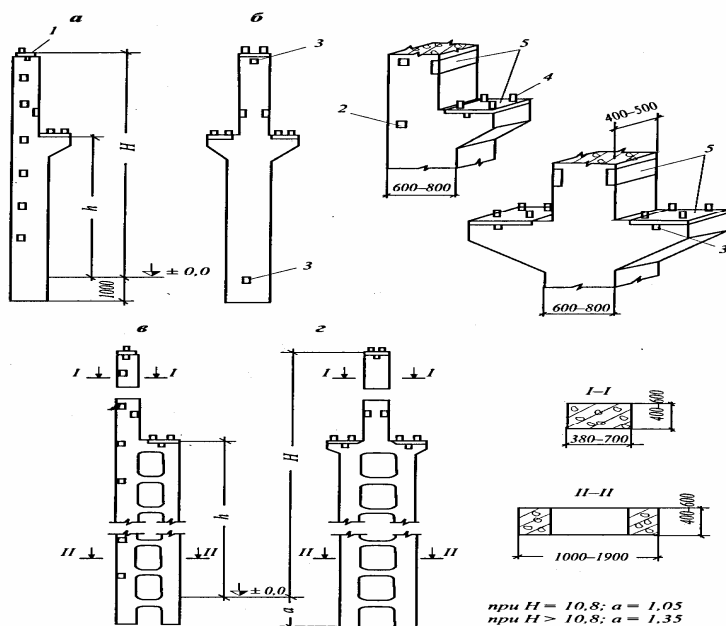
Сборные железобетонные колонны для крановых пролетов:
